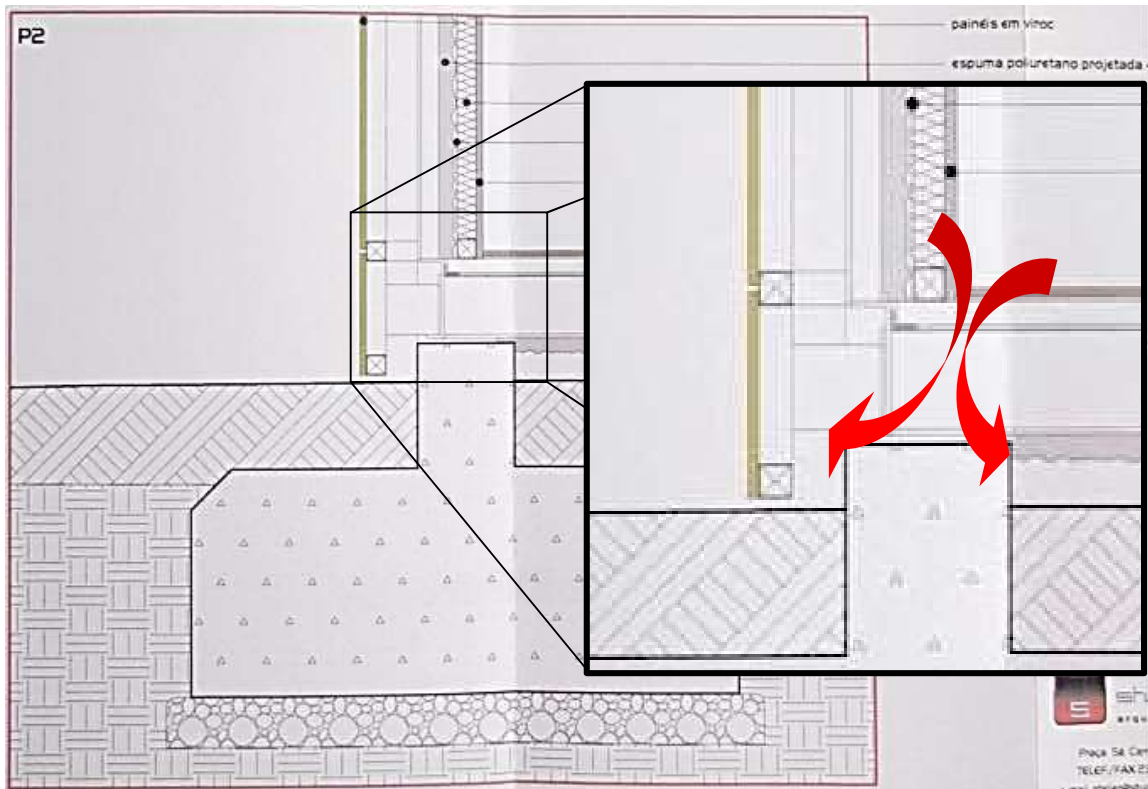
Pontes térmicas na ligação do pavimento com a parede
